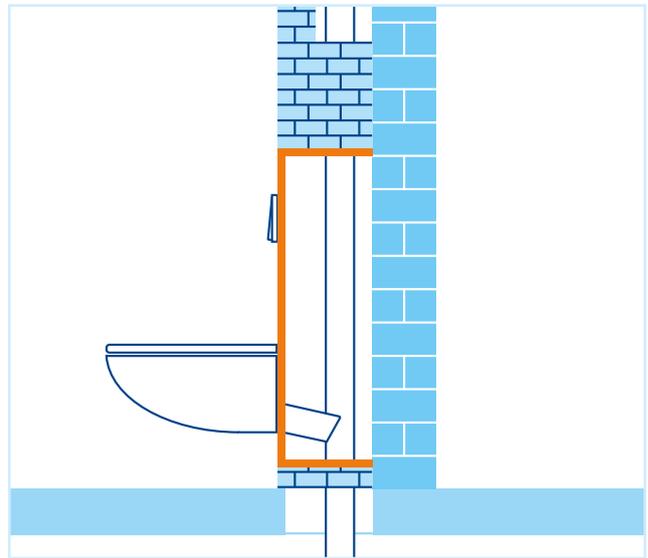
Muro en construcción húmeda frente a muro macizo (basado en la fuente 8)
